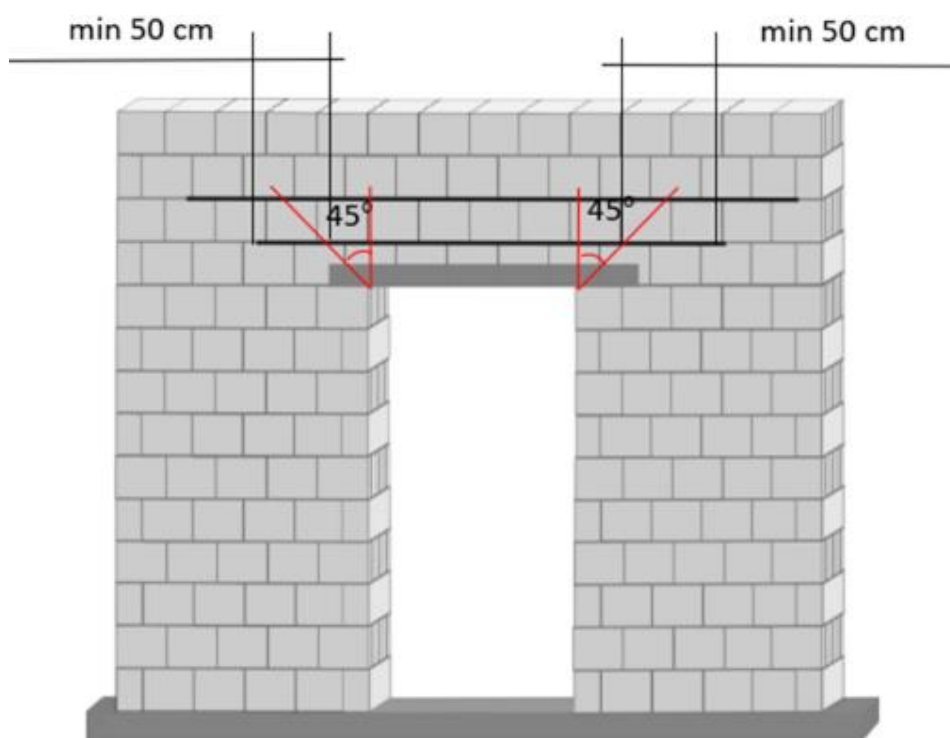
Схема армирования стен и перегородок с дверным проемом
